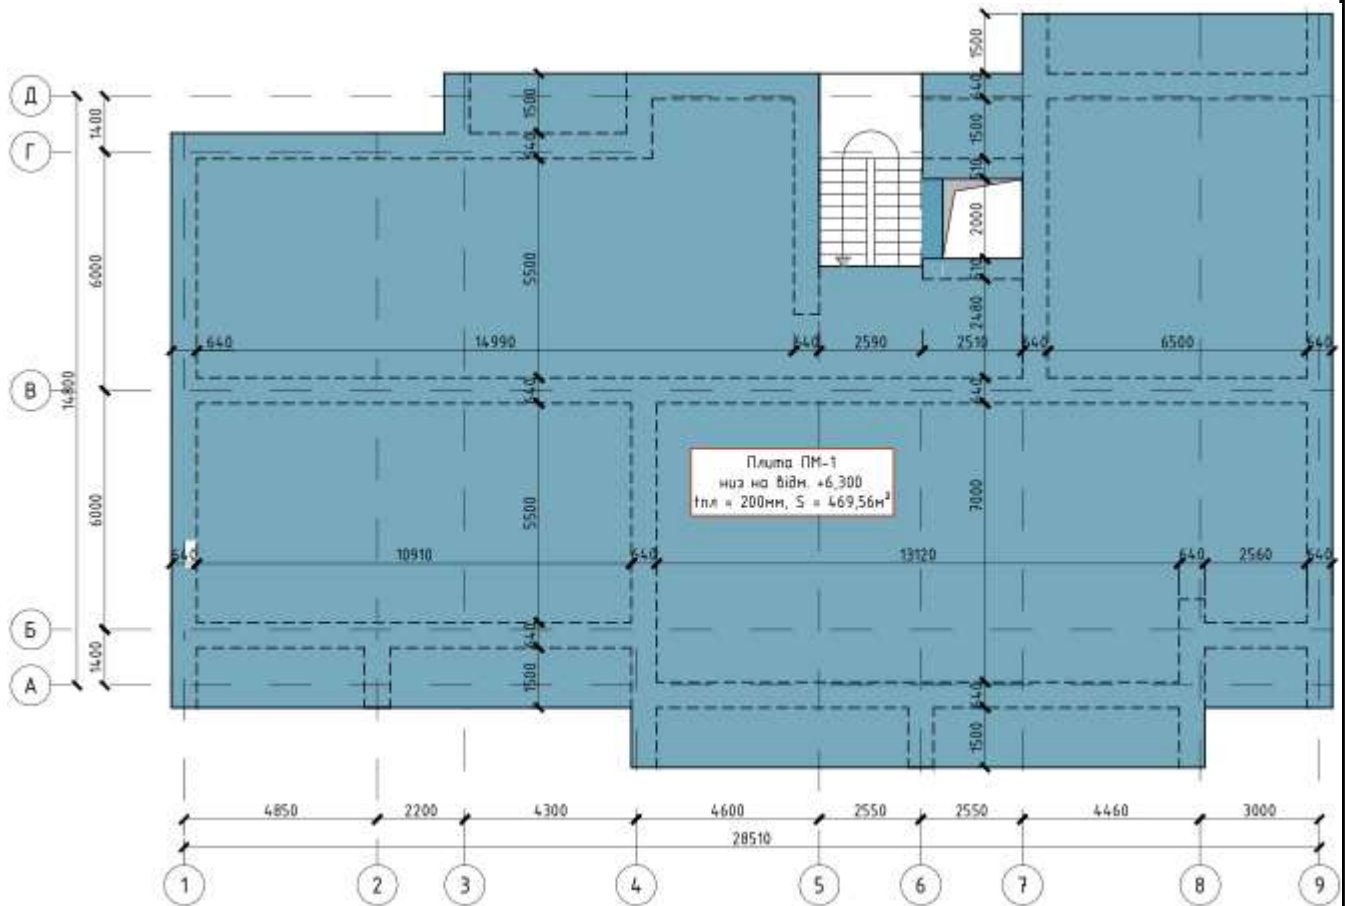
Загальний вигляд плити перекриття типового поверху поверху.
